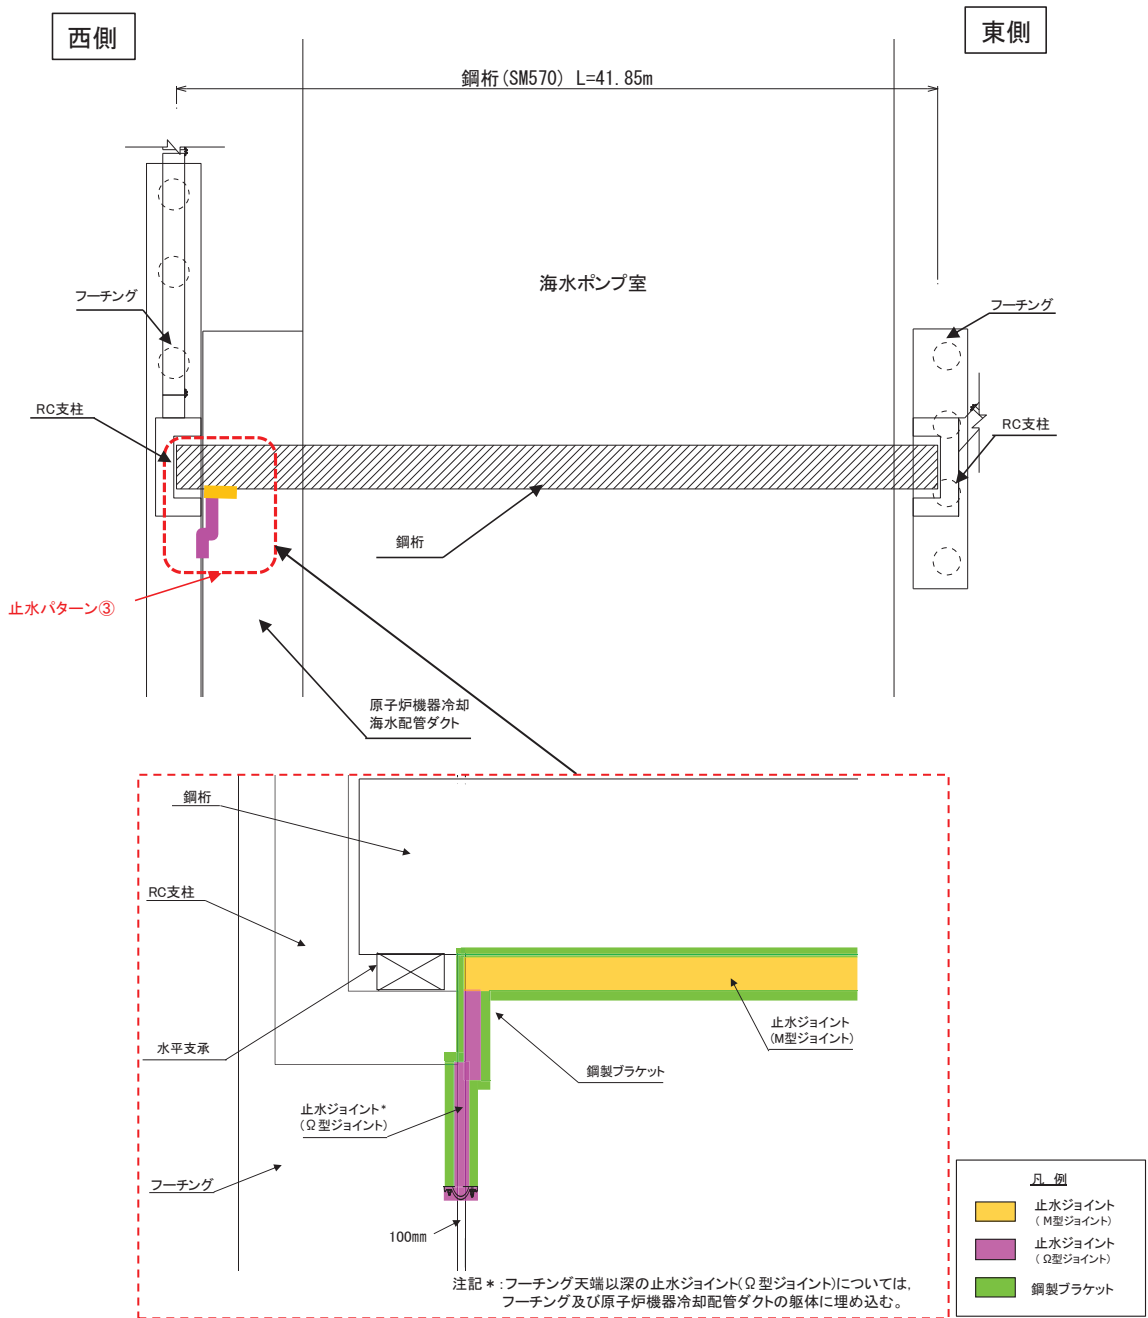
(2) 止水パターン③の構造概要(平面図)
